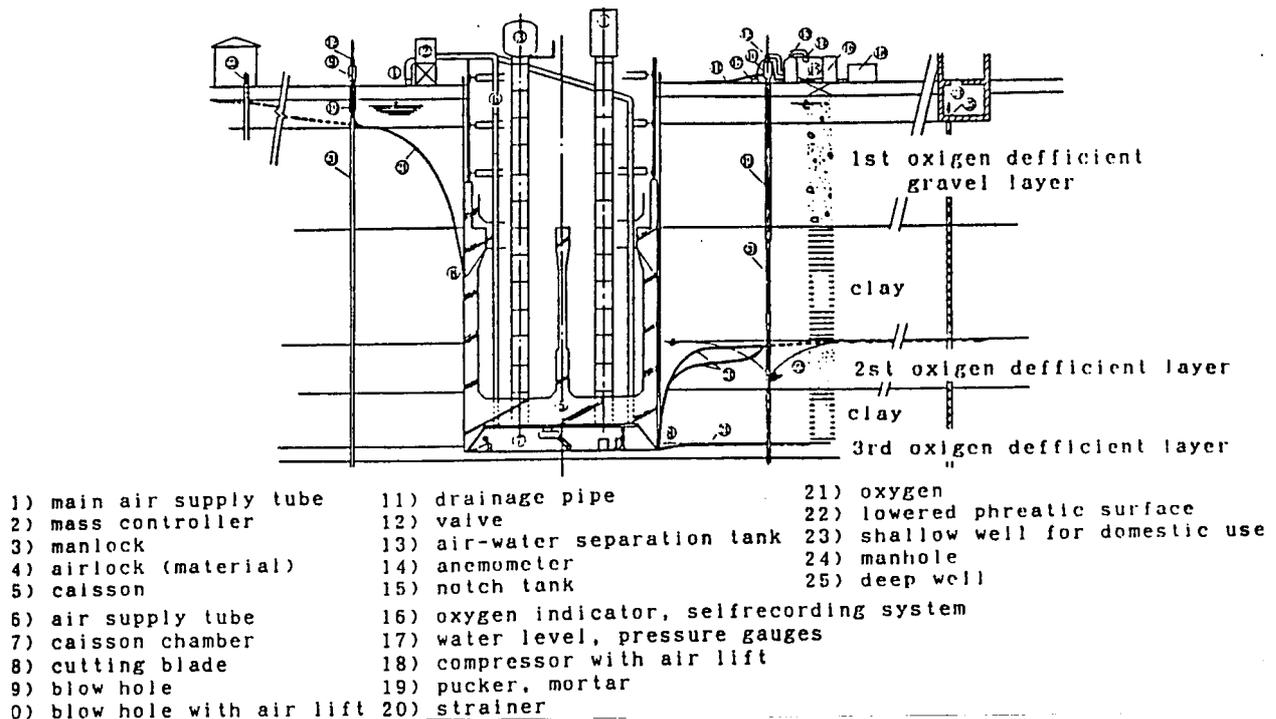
Sistema de injeção -Dry-Grouting-JAPÃO.
